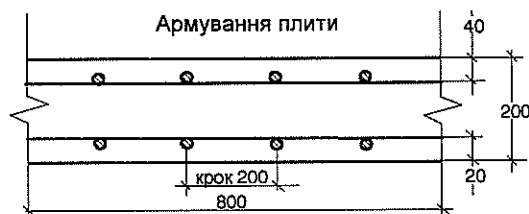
Конструктивна схема фрагменту залізобетонної плити перекриття ПМ-1.
